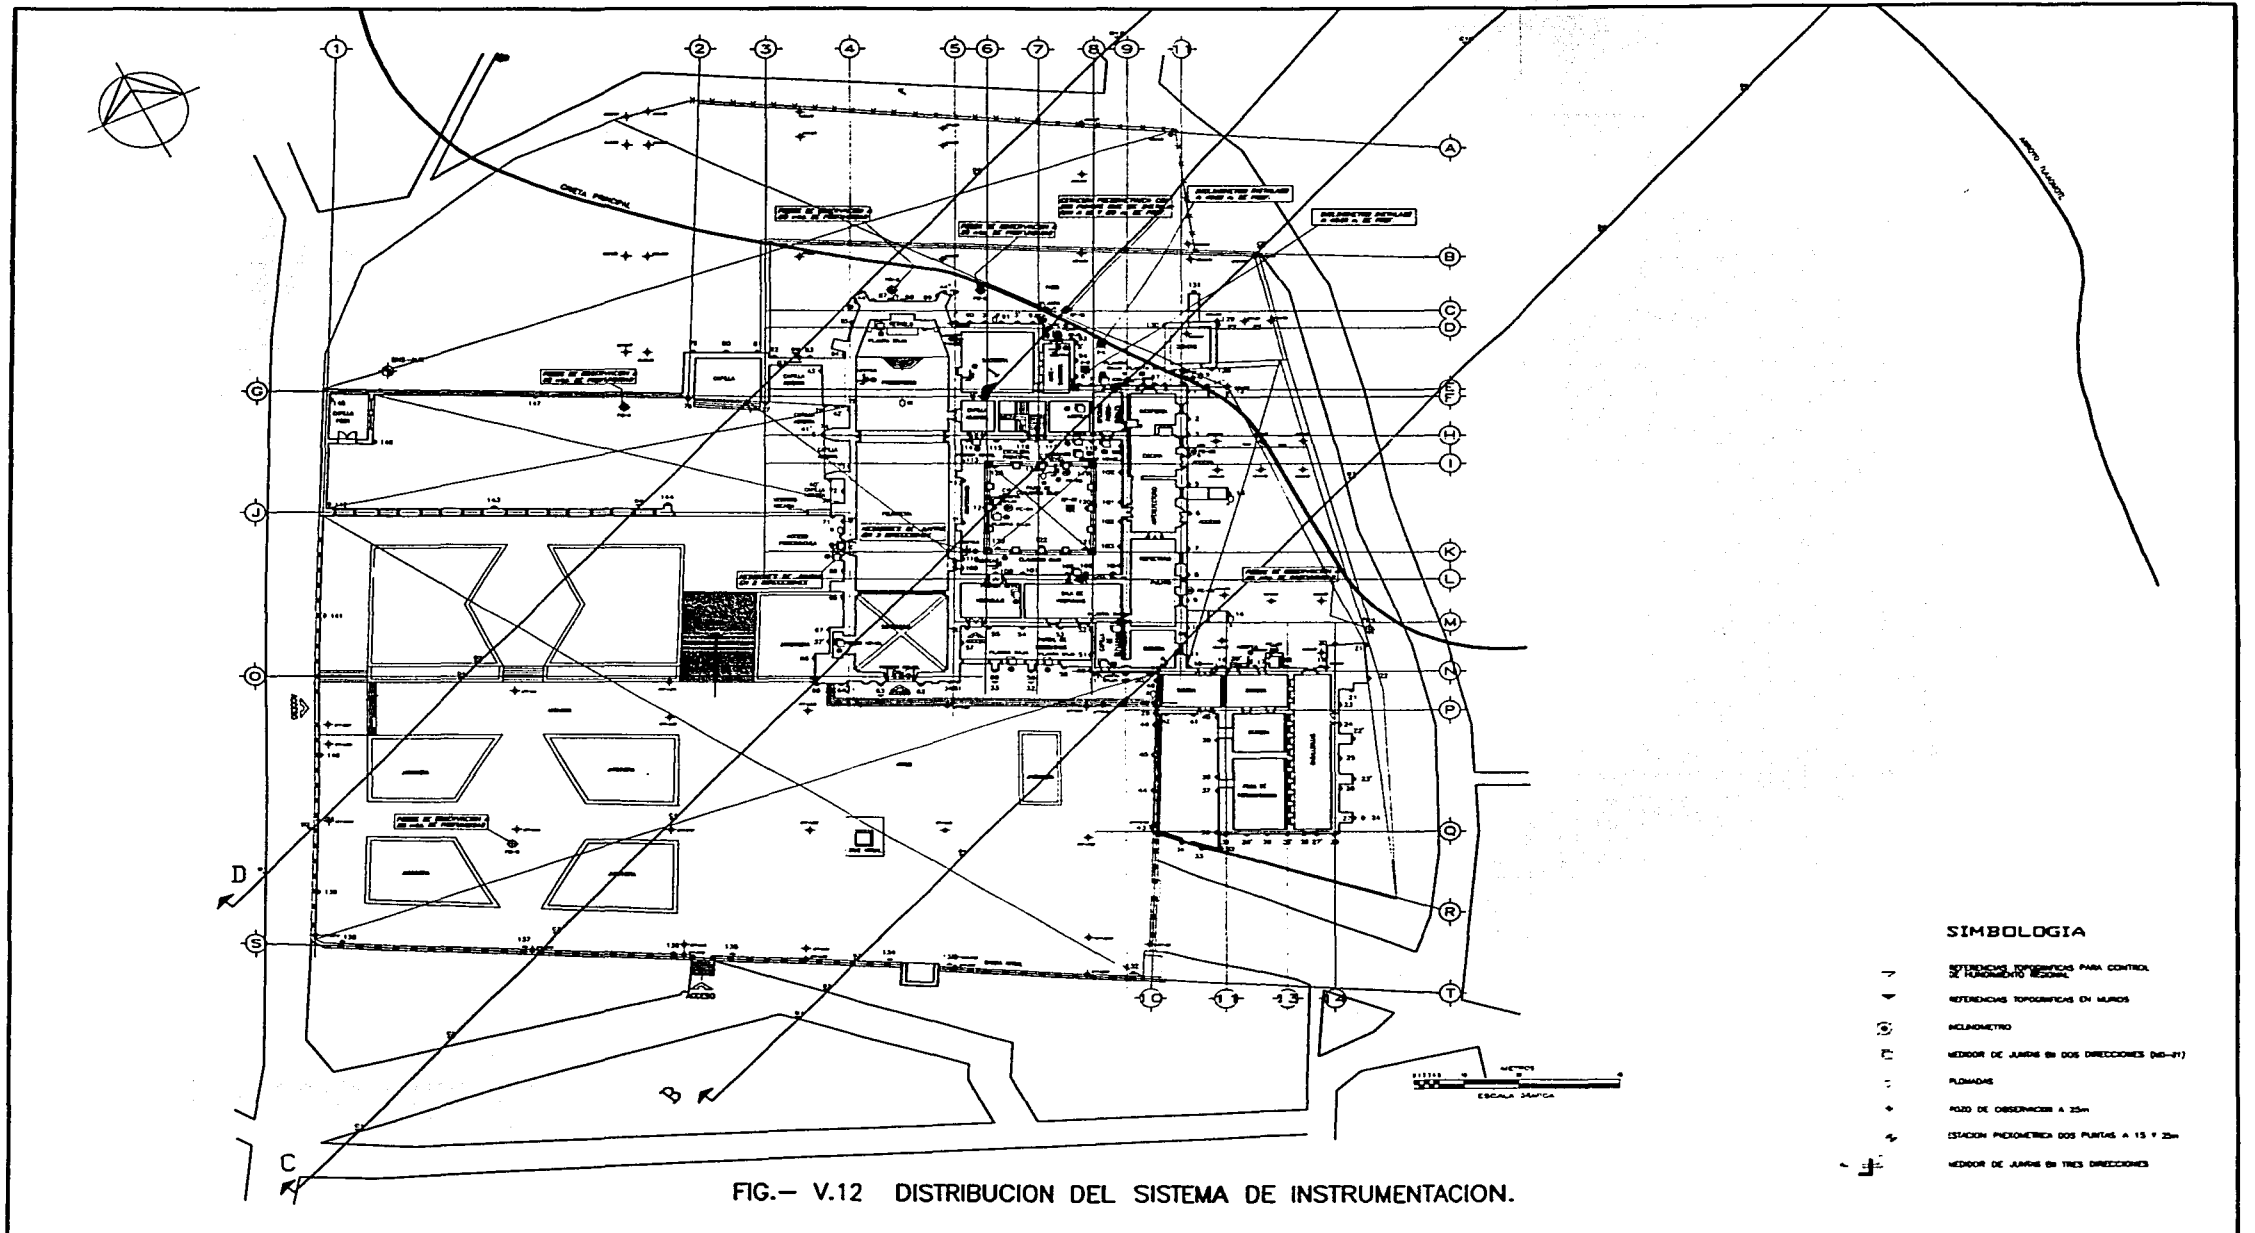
DISTRIBUCION DEL SISTEMA DE INSTRUMENTACION.
